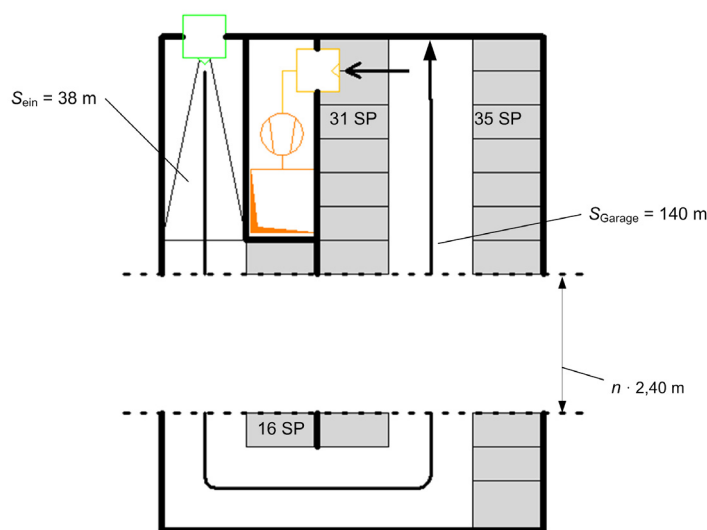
Grundriss Wohnhausgarage mit Längslüftung
